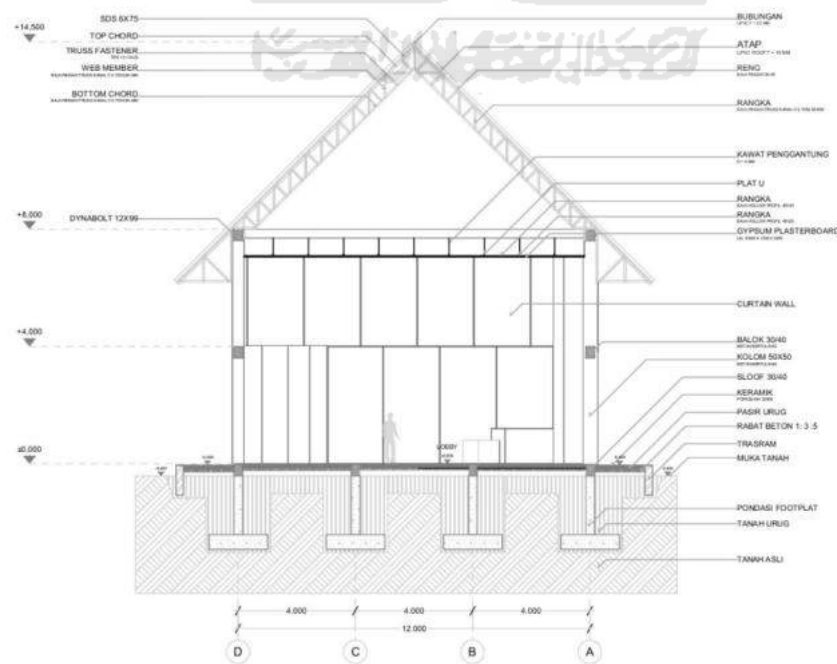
Tampak timur bangunan teater (Sumber: Penulis, 2021)
